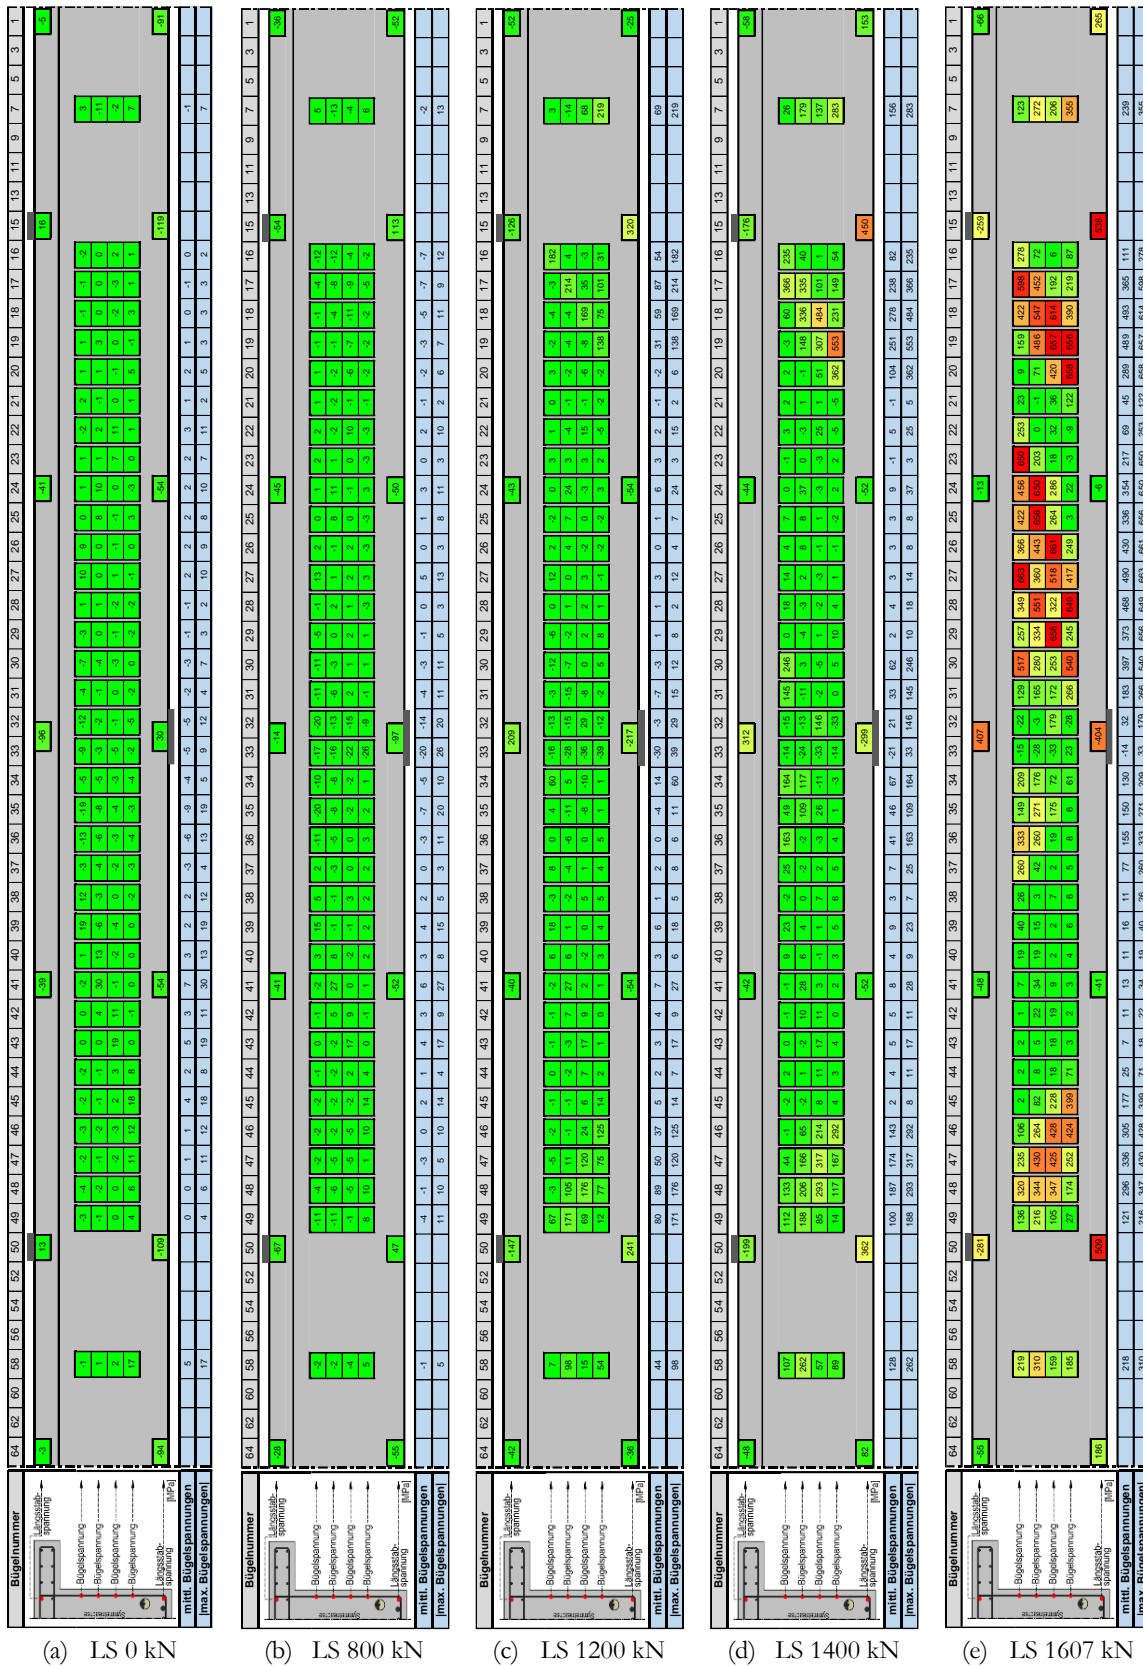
Betonstahlspannungen des Versuchsträgers DLT 2 für ausgewählte Laststufen, Teil 1
